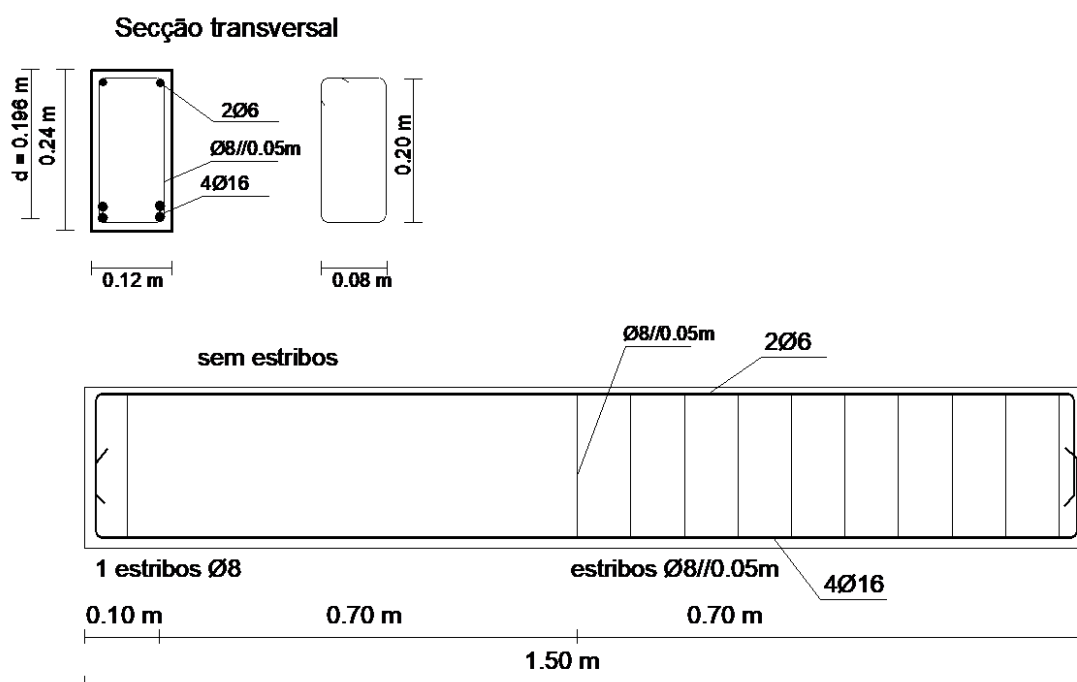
Corte transversal e longitudinal da viga com armadura inferior Ø16 mm
